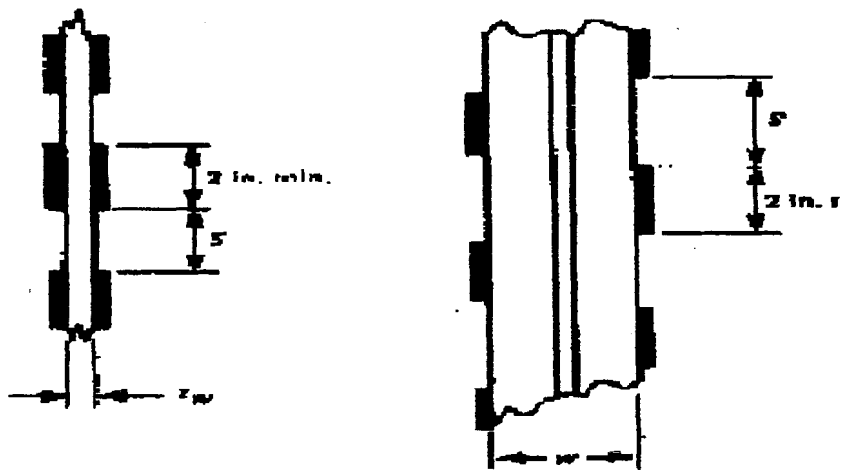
Disposición de cordones de soldadura (Ref. 2)
